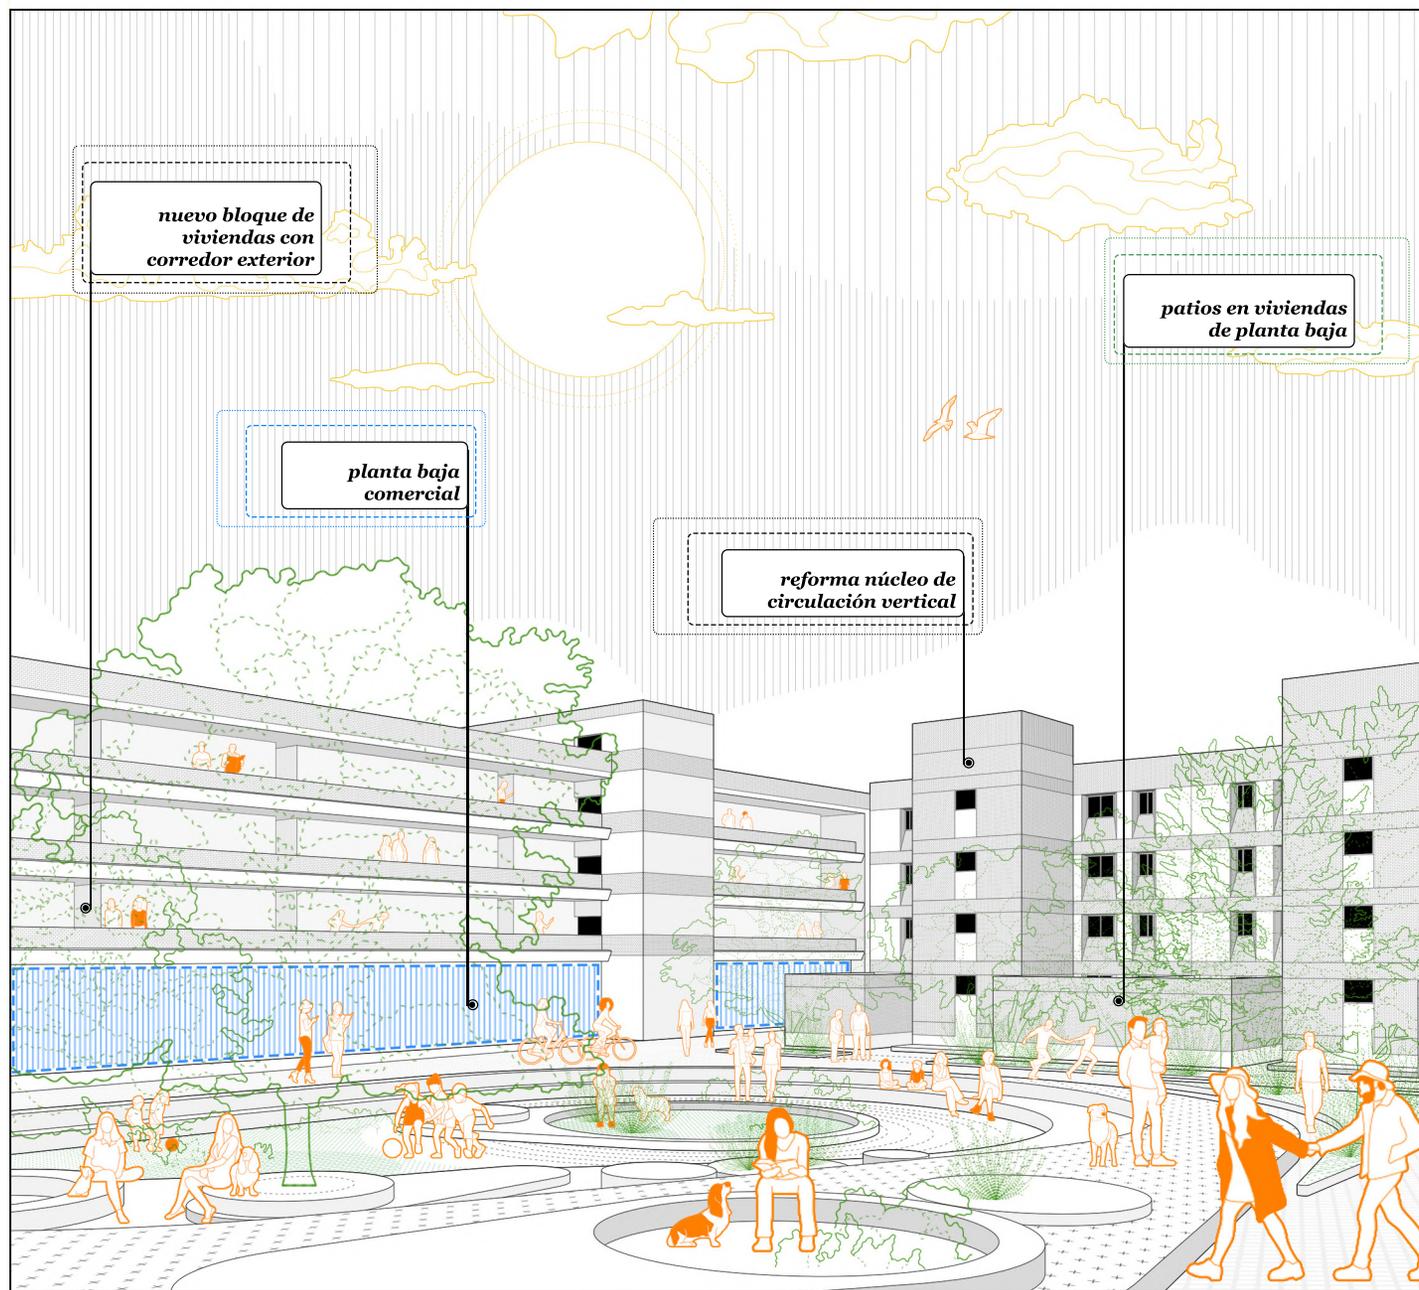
Imagen de espacio libre interior de manzana. Propuesta de intervención Grupo Vicente Mortes.
